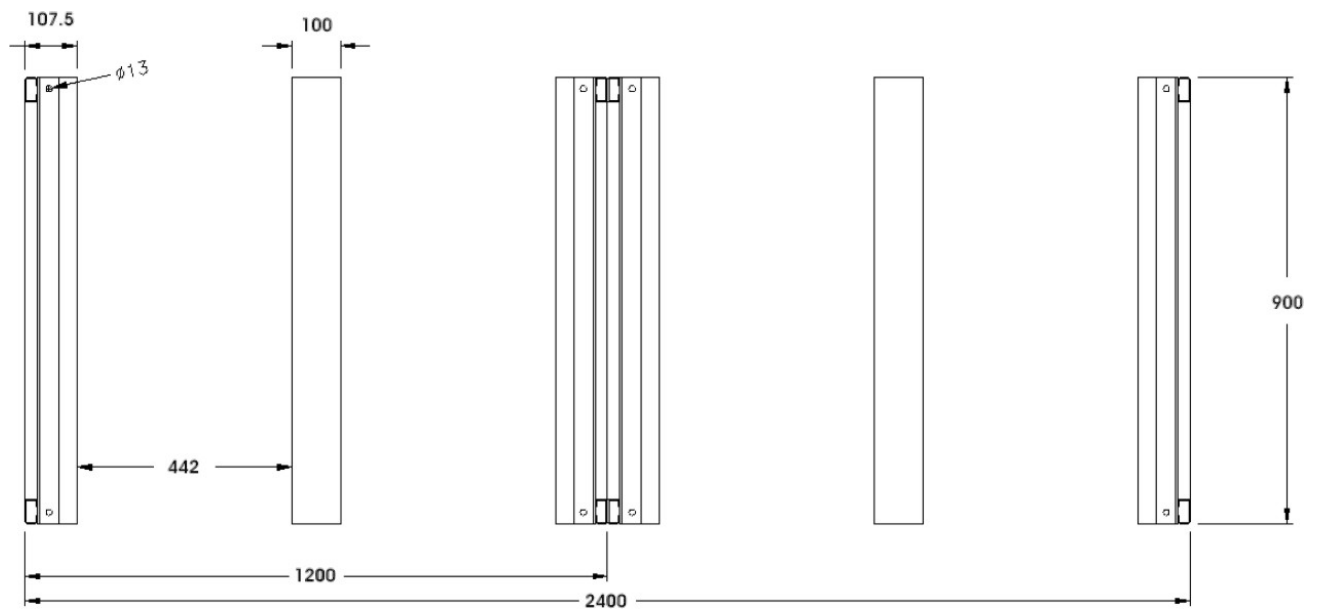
Plan de base de l'UPS 500-600 kVA
